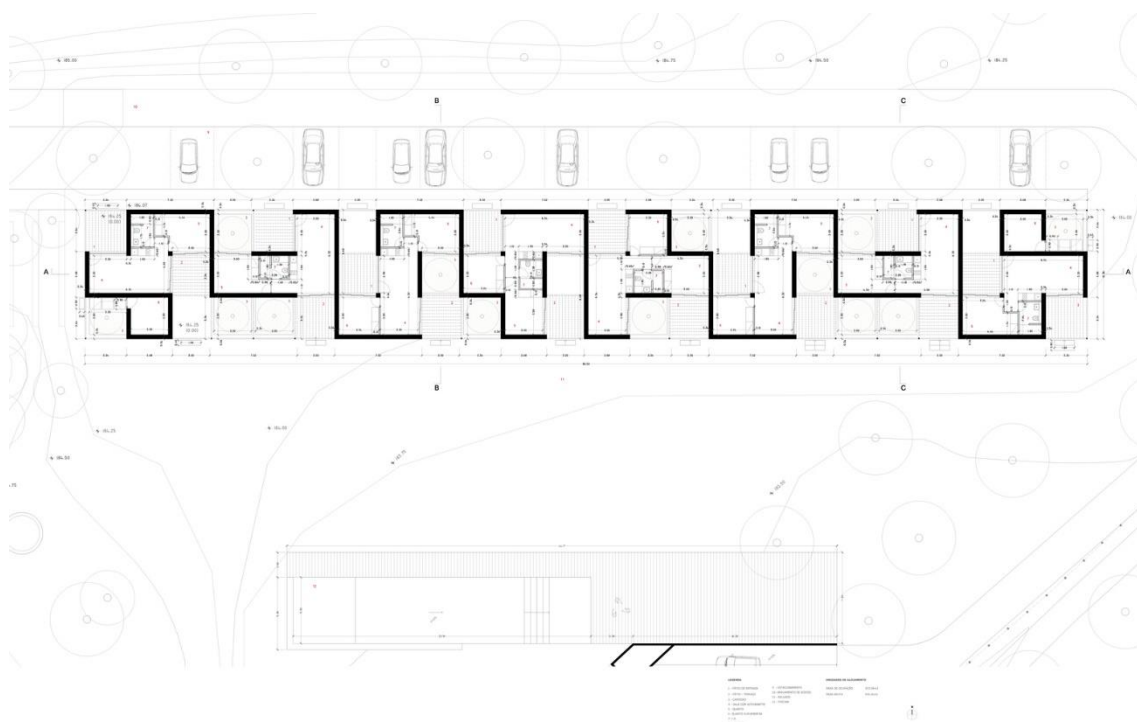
Planta de Implantação dos Alojamentos
